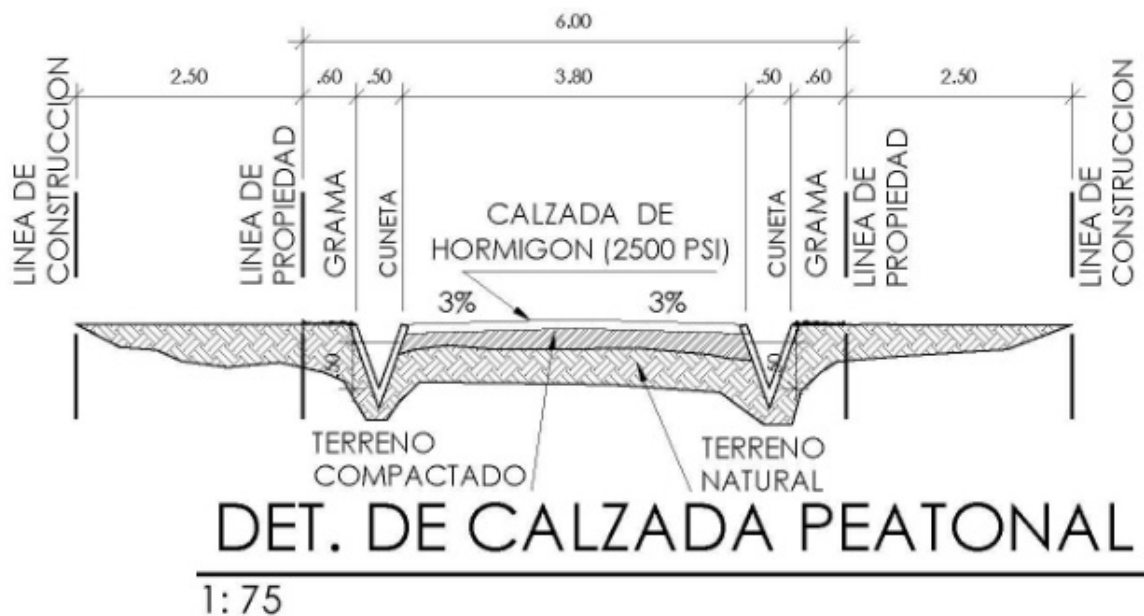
Detalle de calzada peatonal. Fuente: Plano del proyecto.
